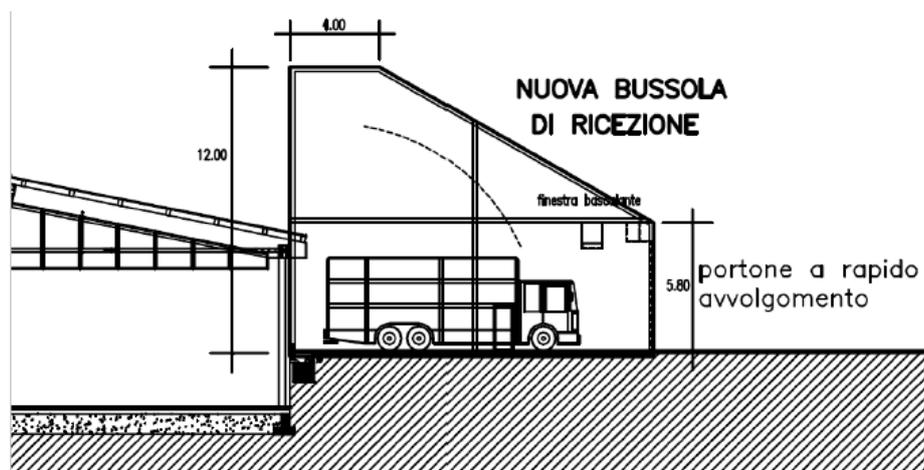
Stralcio planimetrico del progetto di realizzazione della bussola di ricezione.
